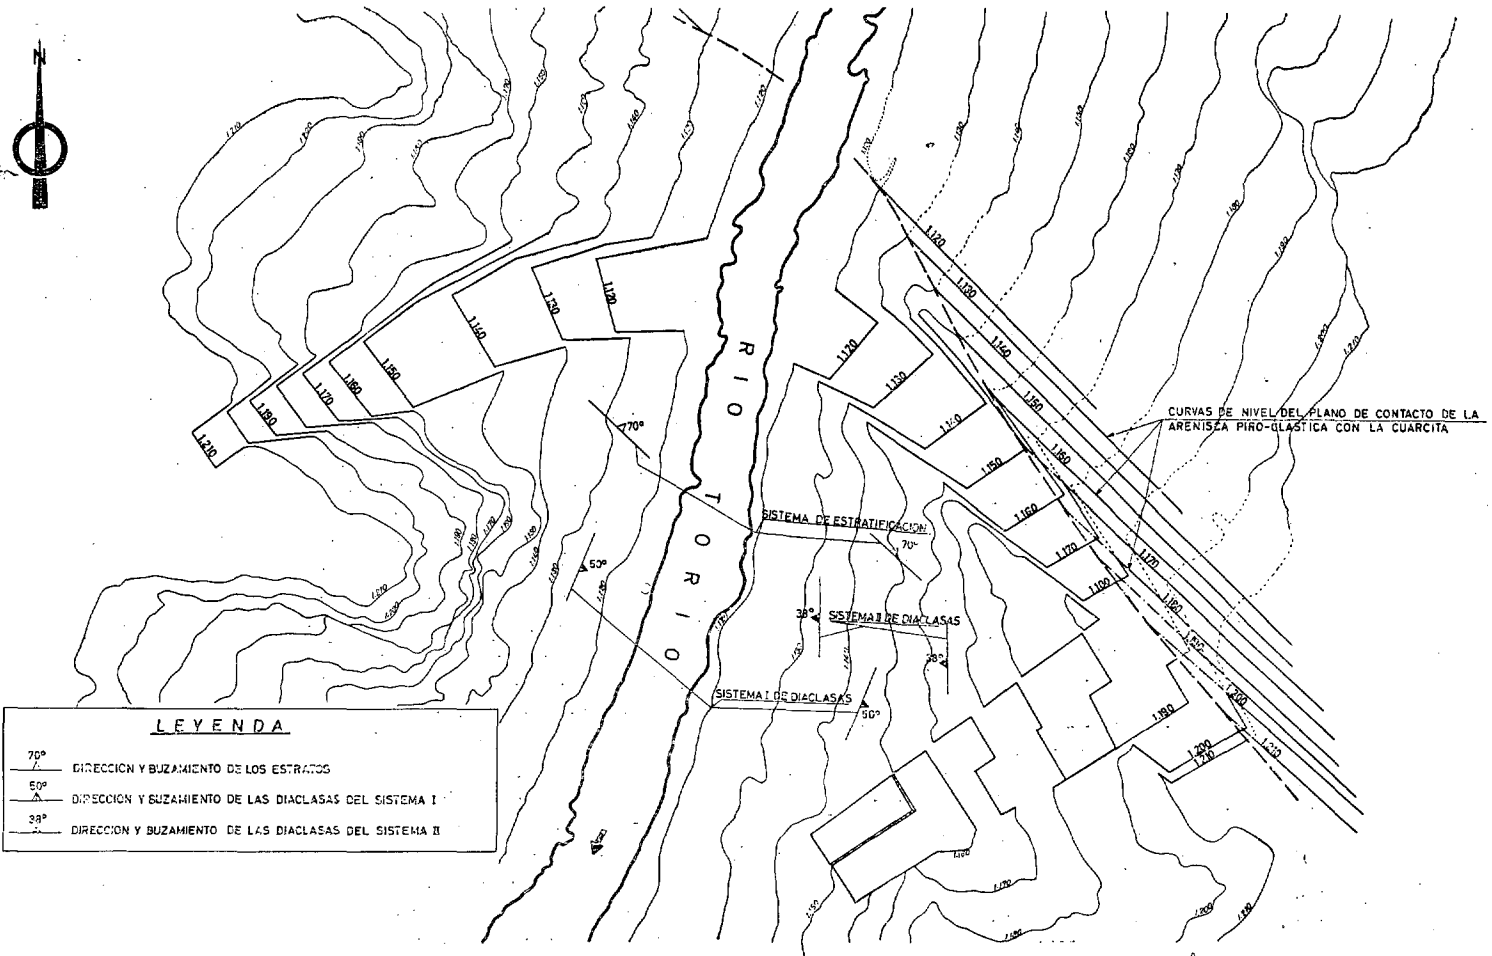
Plano geotécnico y de excavación de la presa (Geotechnic and dam excavations drawing).
